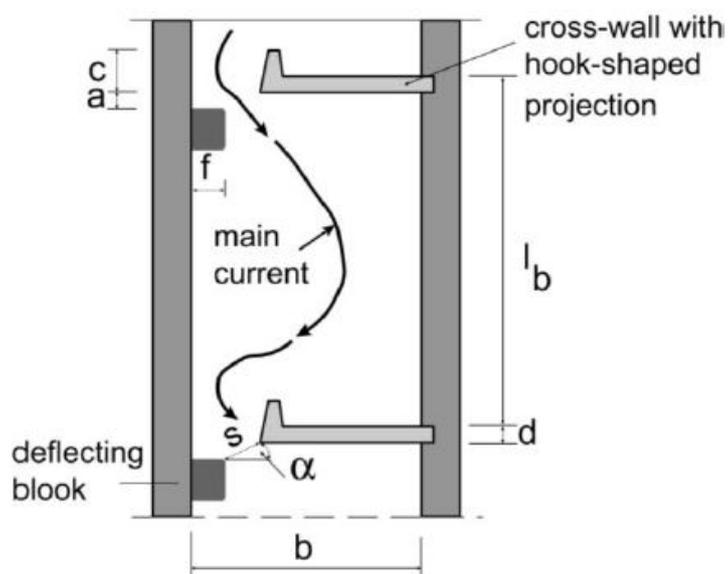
Planimetria della scala di risalita a fessure verticali in progetto.
